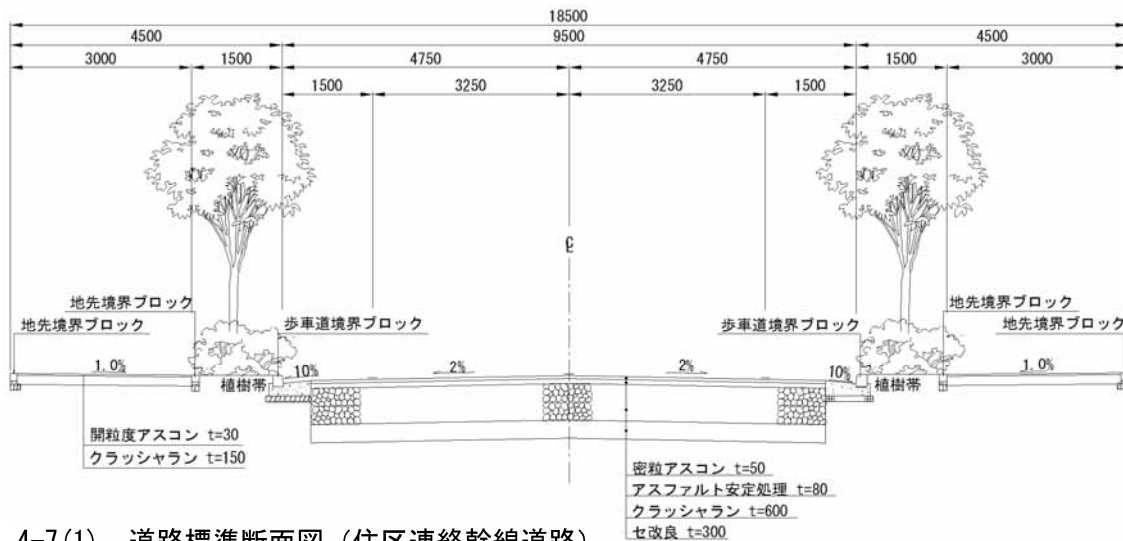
(1) 道路標準断面図（住区連絡幹線道路）
